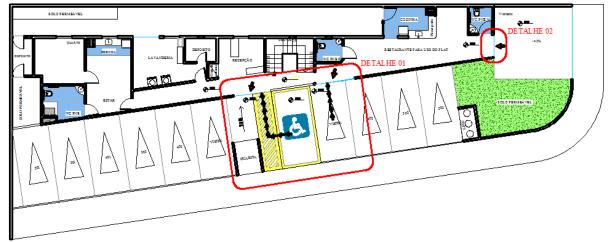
Planta Baixa - Pavimento térreo (1)
